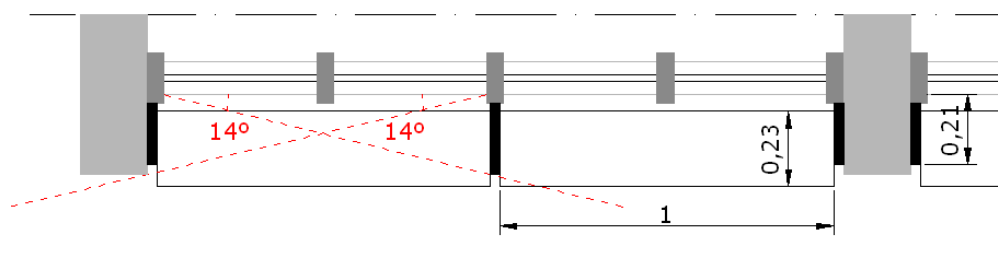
Planta esquemática com protetores verticais com cotas em metro (m).
